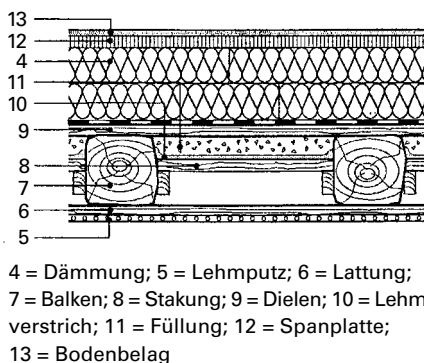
Holzbalkendecke mit begehbarer Dämmung und Dampfsperre
